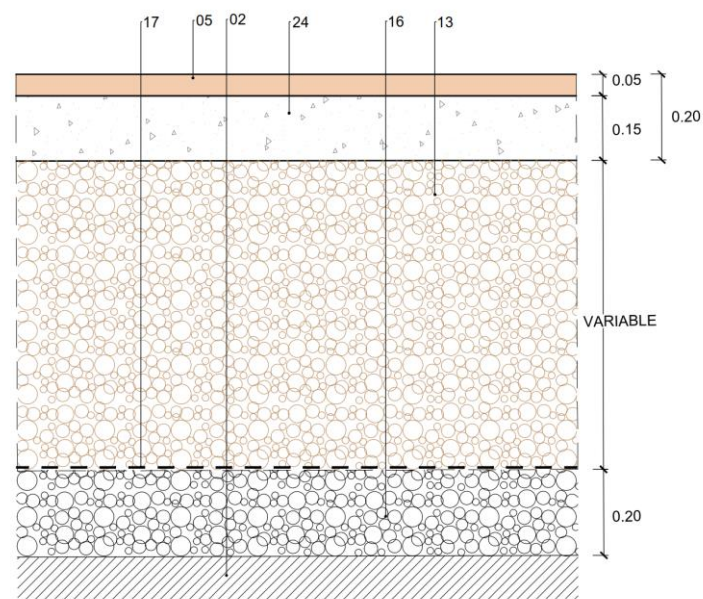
Sección tipo carril bici con pavimento de hormigón coloreado
